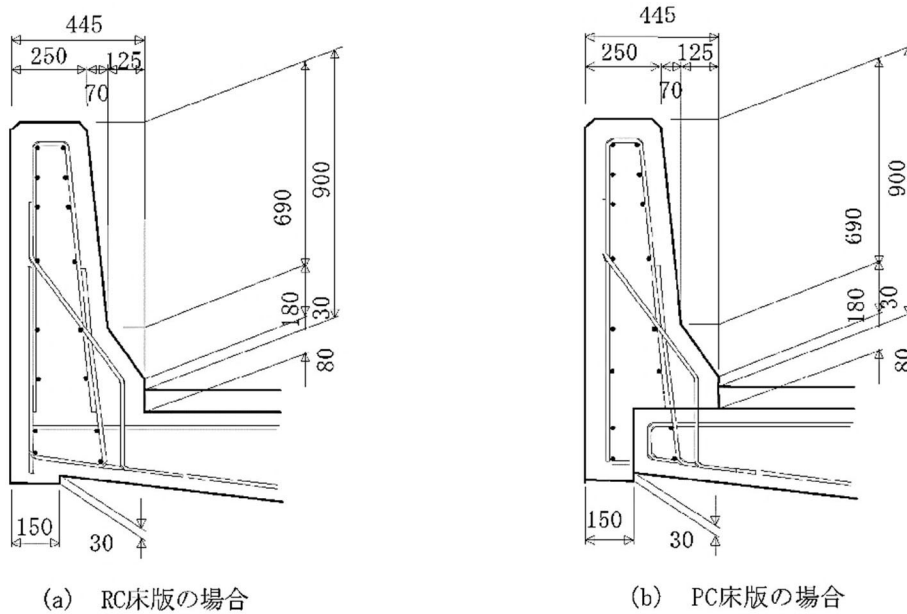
鉄筋コンクリート製壁型防護柵の配筋例（種別SB）
